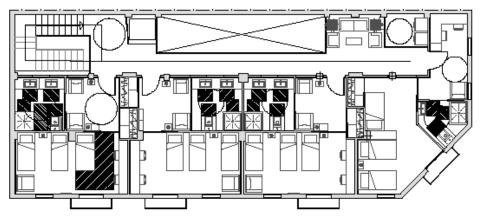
Plano de planta segunda propuesta. Elaboración propia
